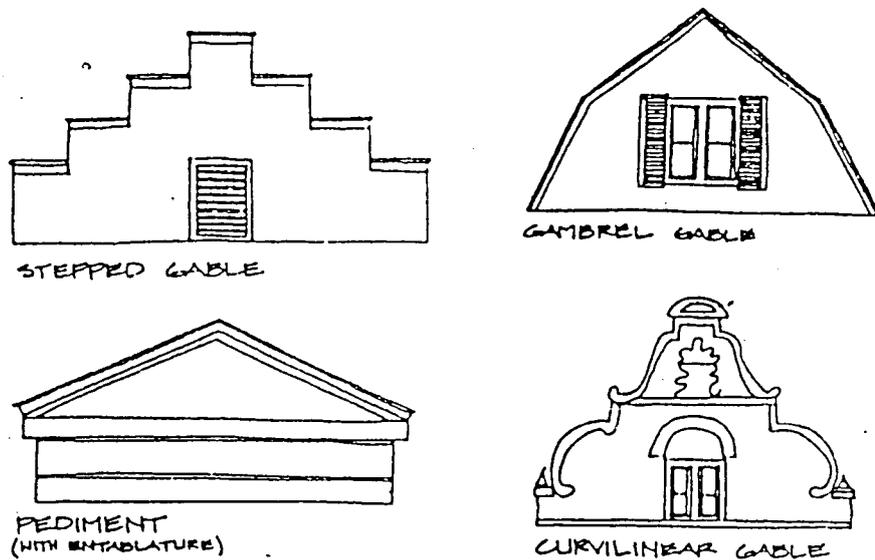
Tampak Bangunan Arsitektur Kolonial Belanda
